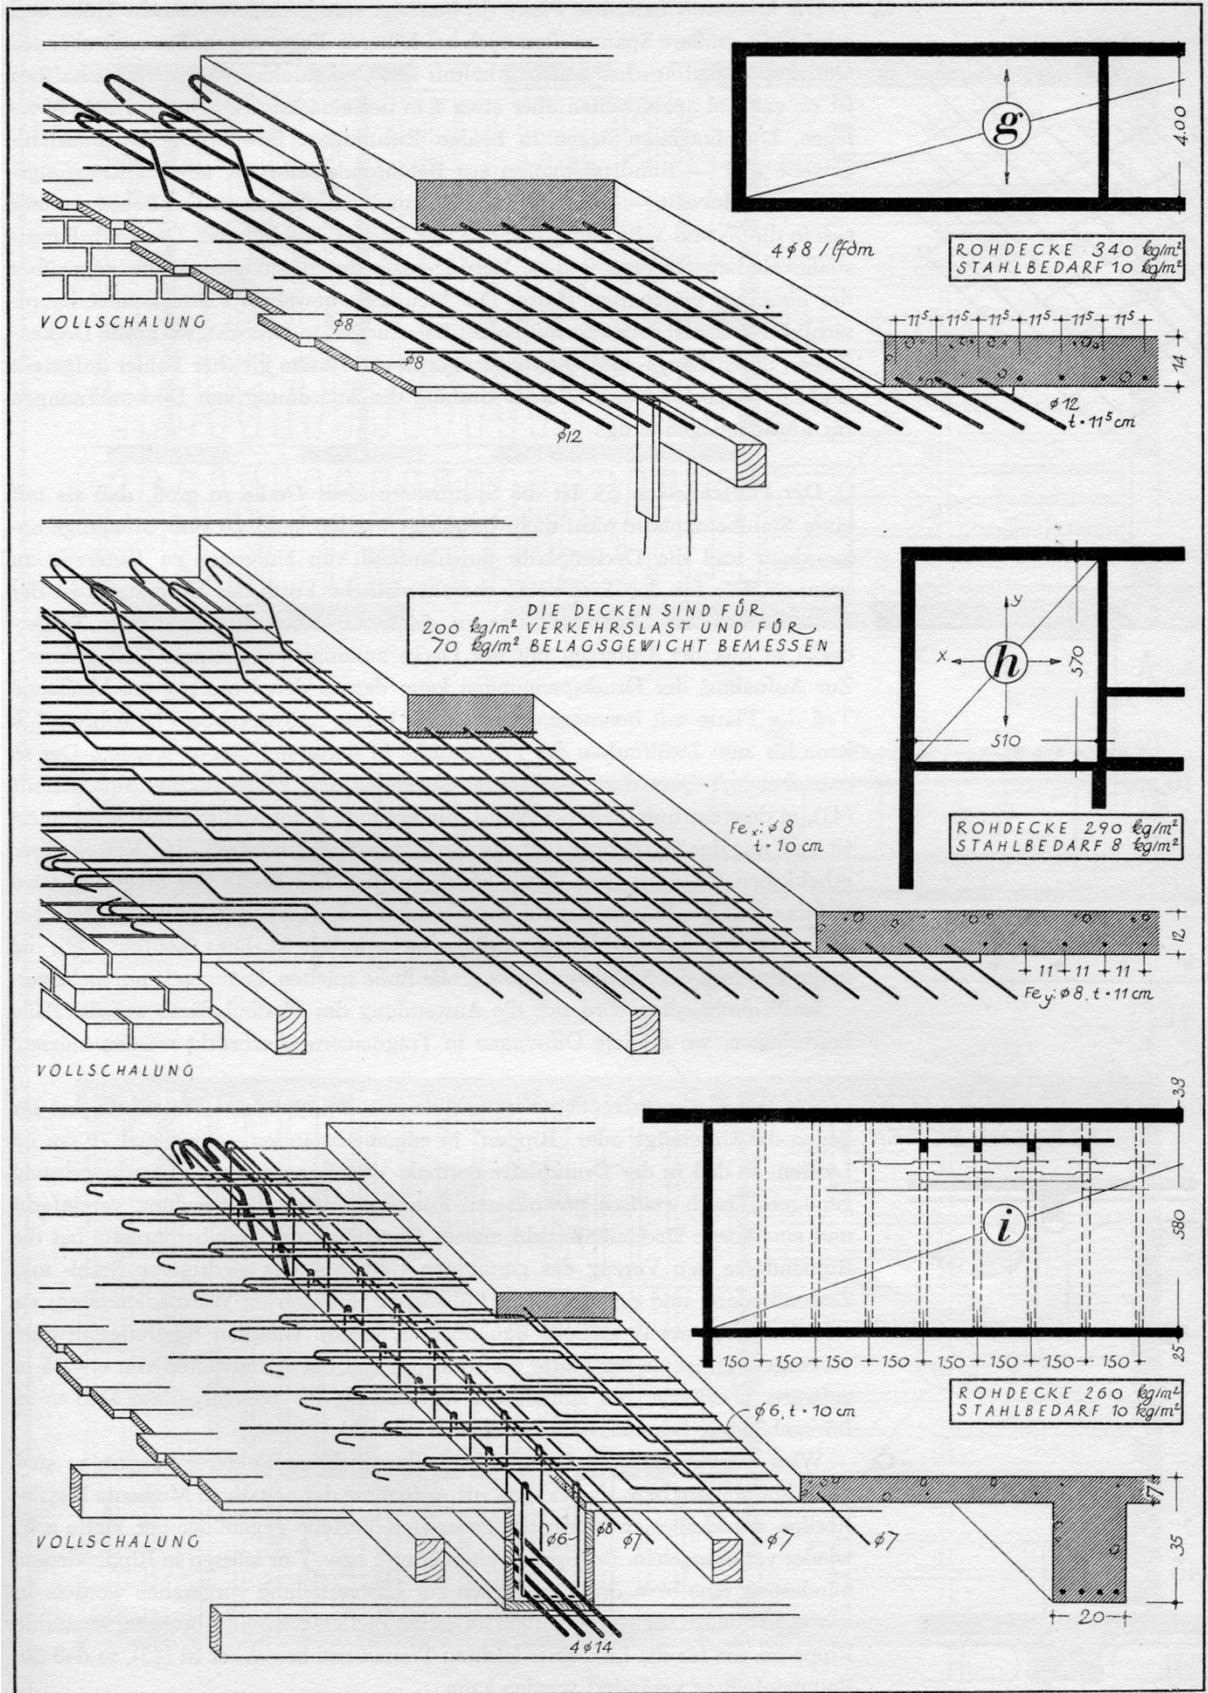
Stahlbetonplatten aus Franz Hart, Baukonstruktion für Architekten, 1950
